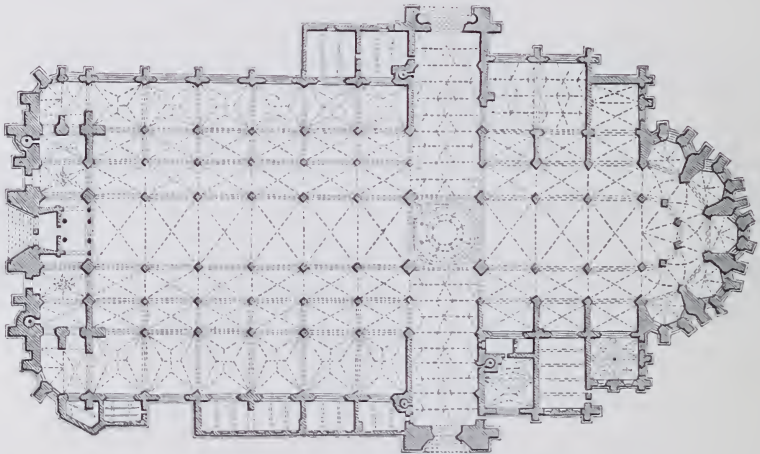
Grundriss der Kathedrale zu Antwerpen.
